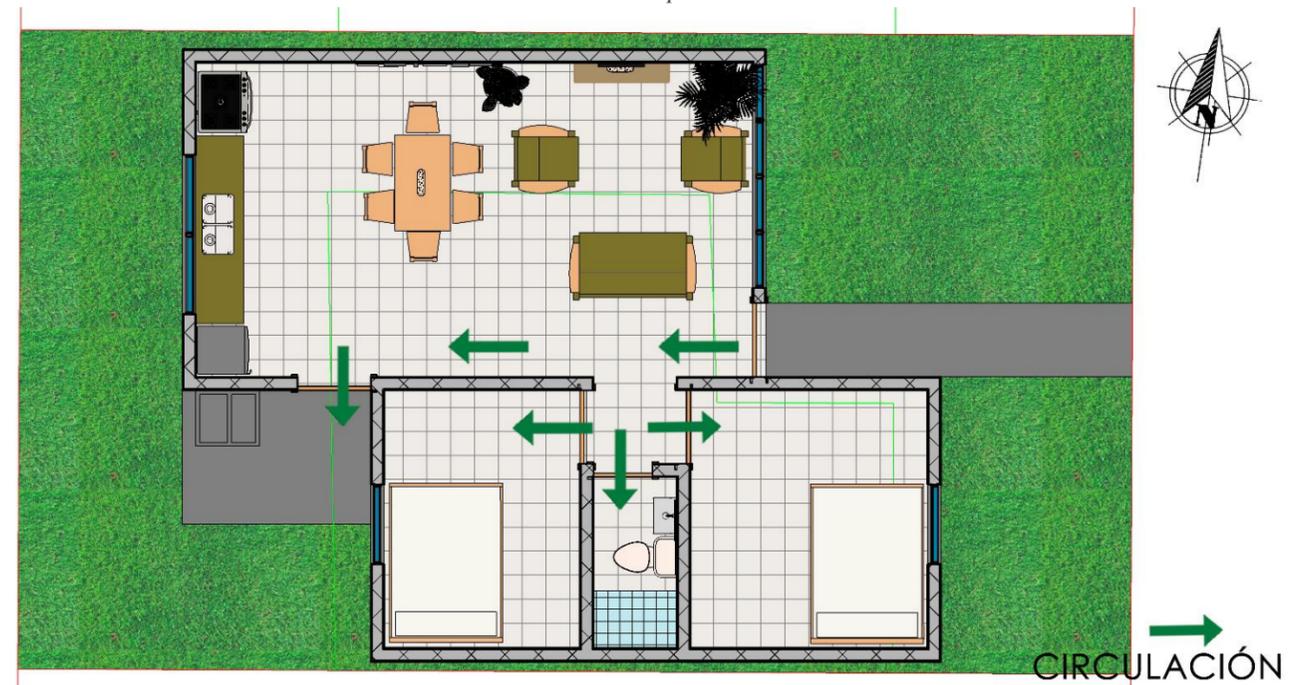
Propuesta Planta de Circulación Vivienda Modelo C-12.
